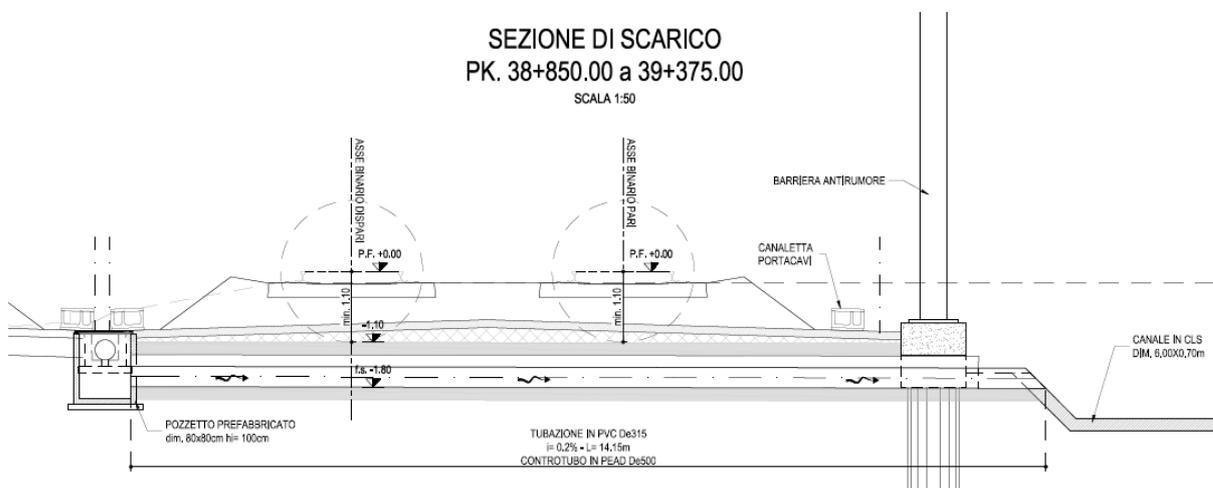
Sezione di scarico delle canalette centrali nei fossi di guardia posti al piede del rilevato.
